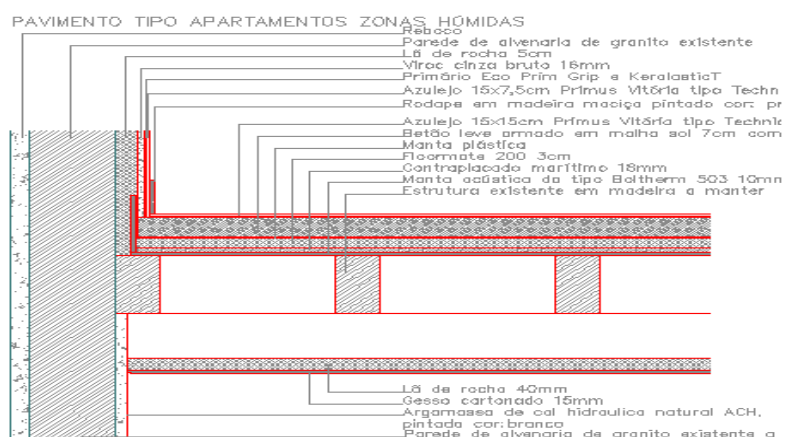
Pormenor do pavimento do piso das habitações das zonas húmidas.
